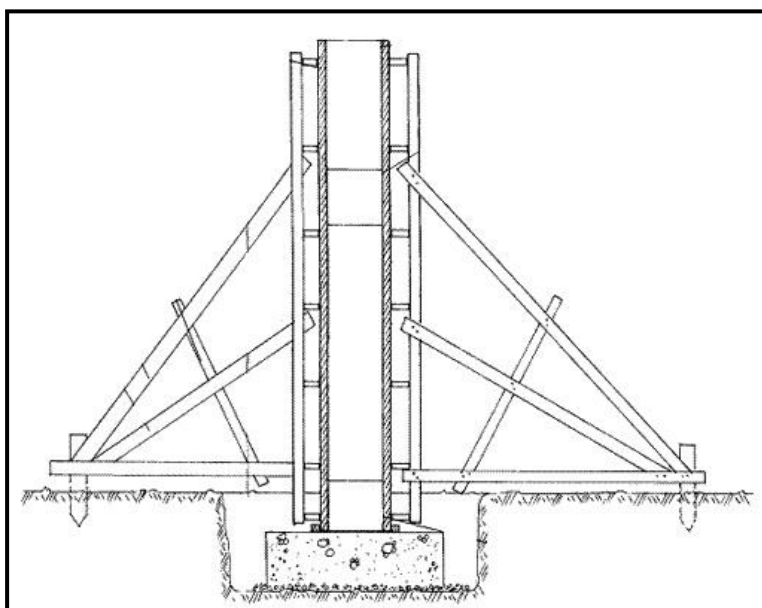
Detalhe de escoramento e contraventamentos em formas de pilares
